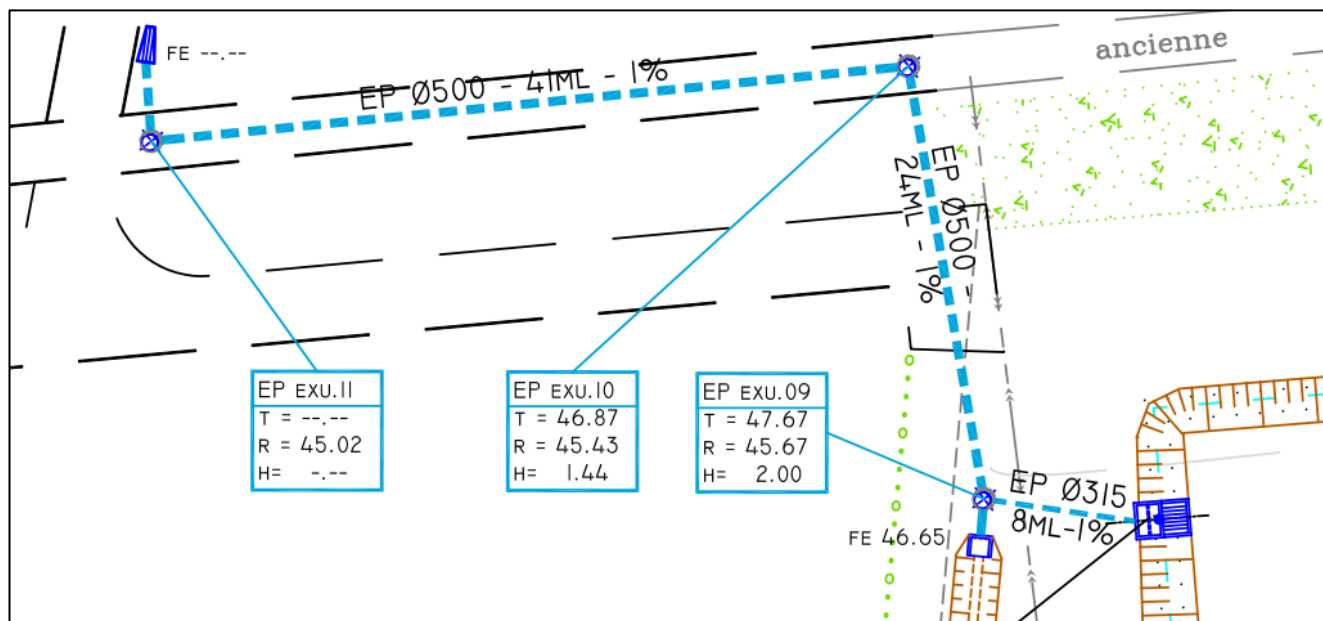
Extrait Plan 5.c.3 – PLAN D'ASSAINISSEMENT Z.A. (communauté de communes du Canton de Candé)
